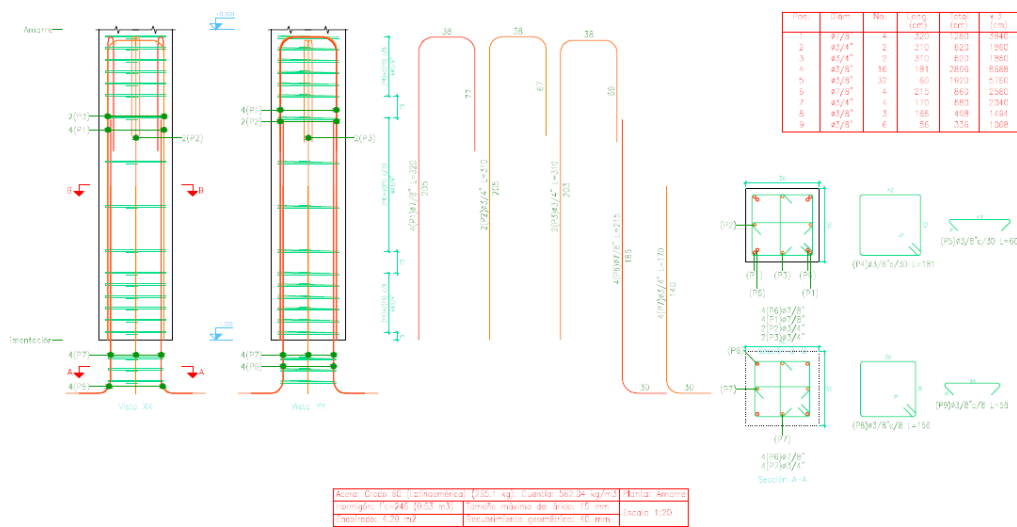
Despiece de Columnas. Colegio. CAJAMAG.
